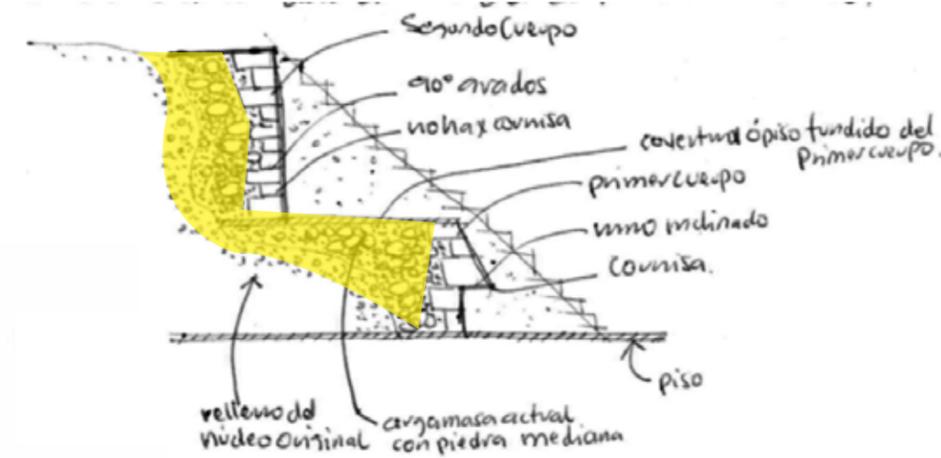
Dibujo Edificio 1 Corte este - oeste, restauración en faldón y remetiemento del primer cuerpo y restauración en muro vertical segundo cuerpo Dibujo: GAMH 2002
